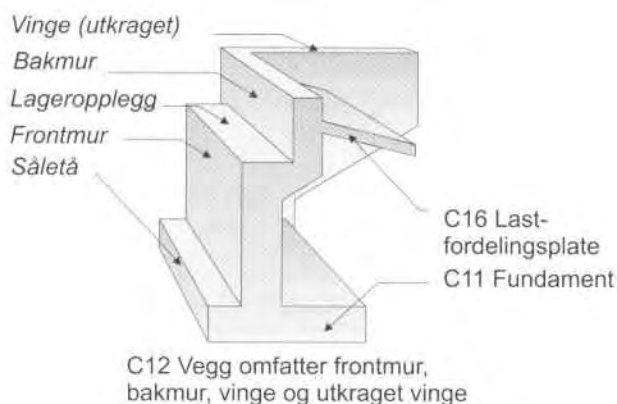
til Figur 2.3-4 viser de vanligste elementene som inngår i grunnen og underbygningen.
